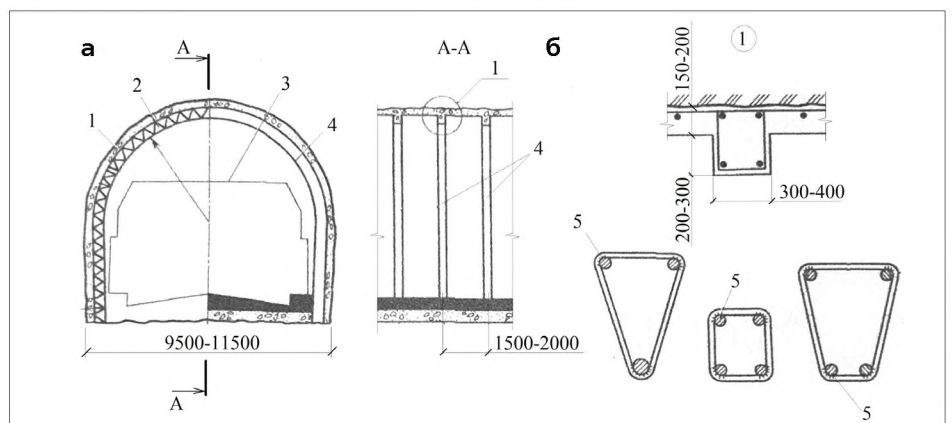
Ребристая обделка из набрызг-бетона с решетчатыми арками (а) и конструкции арок (б): 1 – слой набрызг-бетона; 2 – решетчатые арки; 3 – контур габарита; 4 – внутренние ребра; 5 – арматурные стержни
